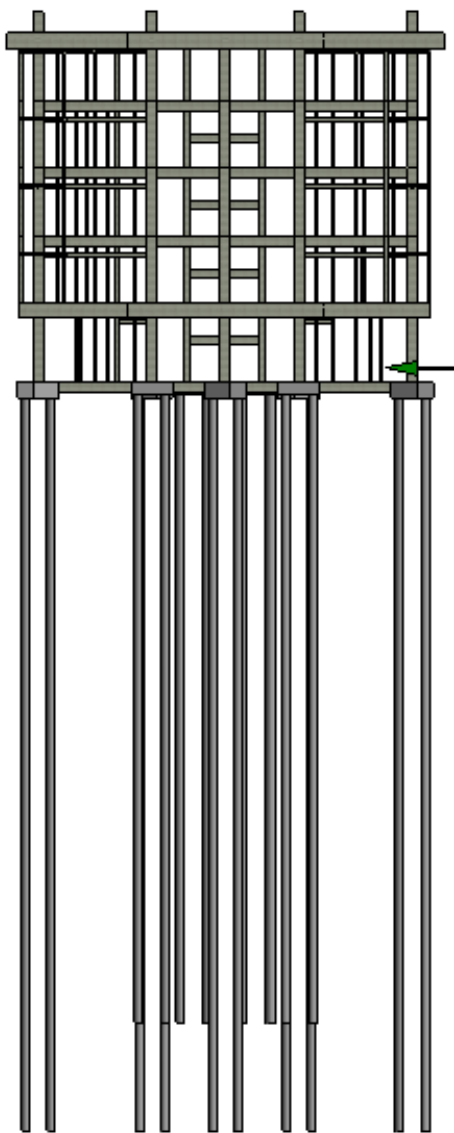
31 Model Struktur Bangunan (Tampak Depan)
